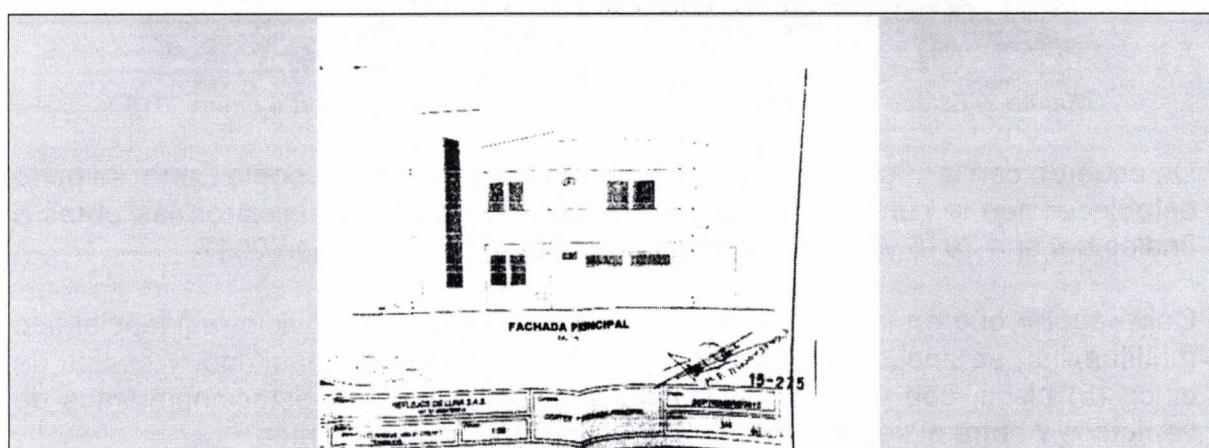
plano fachada principal proyecto radicado en curaduría – año 2015
